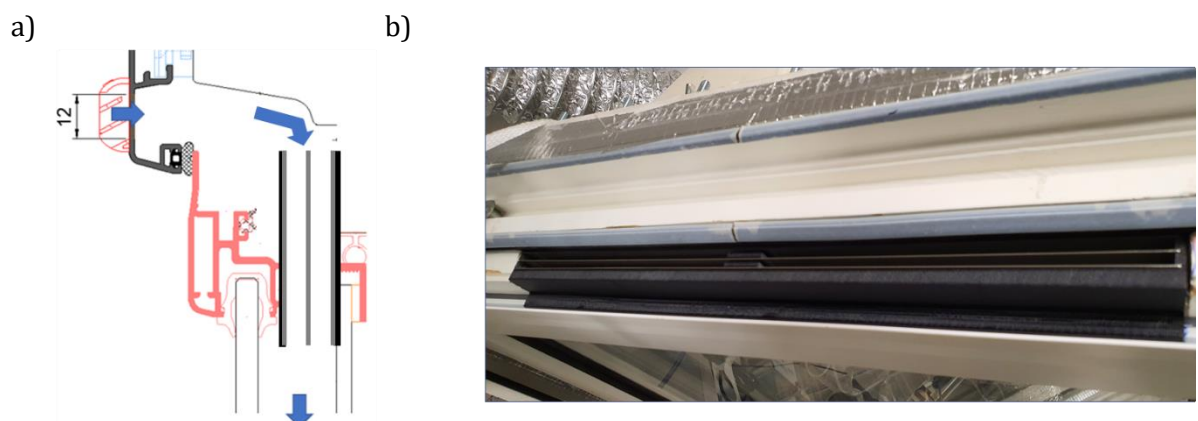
a) Schéma et b) photo du collecteur longitudinal en entrée de fenêtre (CLe).
